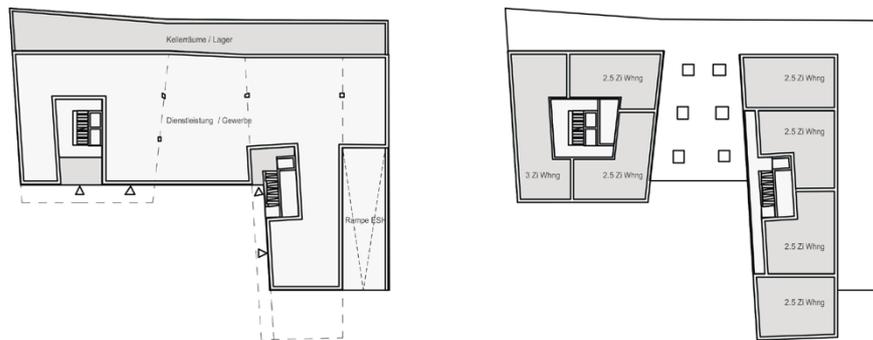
Prinzip-Grundrisse Erdgeschoss (links) und Obergeschosse (rechts)
